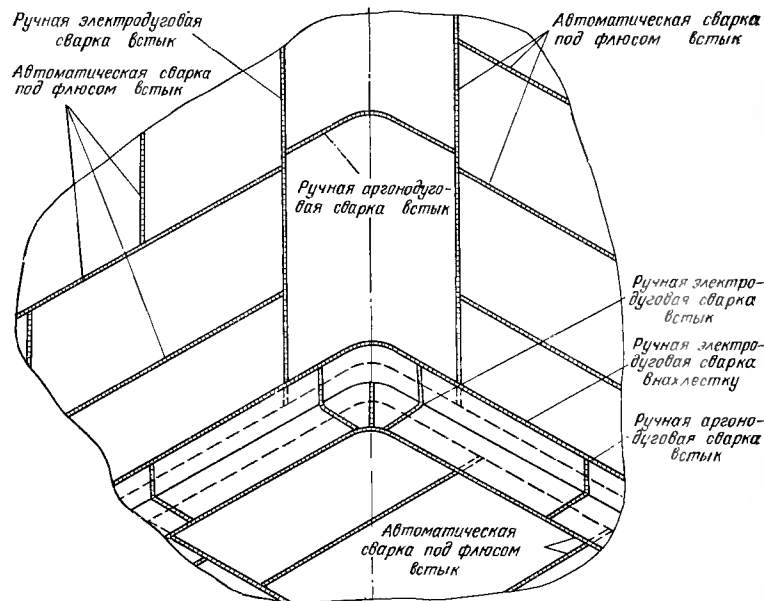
Схема сварки облицовки спецпомещений АЭС.
